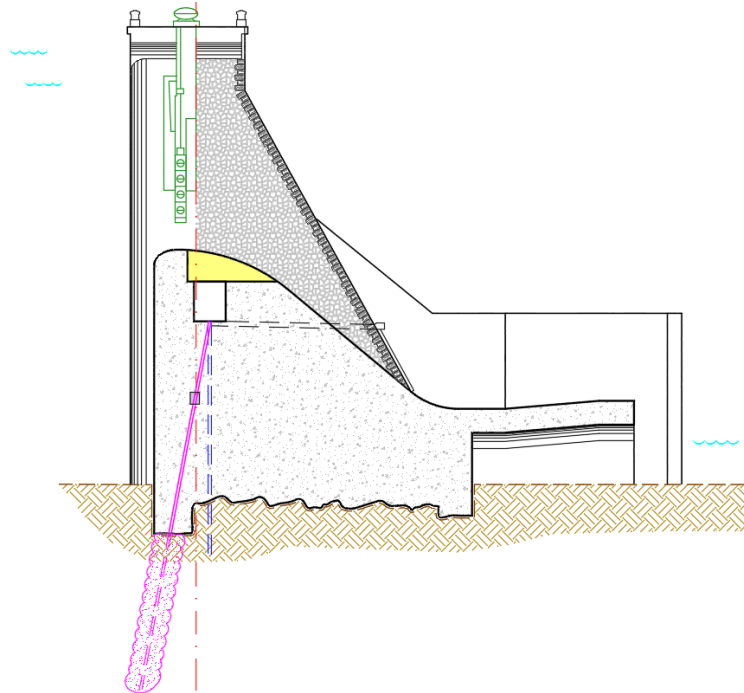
Interventi di progetto – Sezione su scarico di fondo
